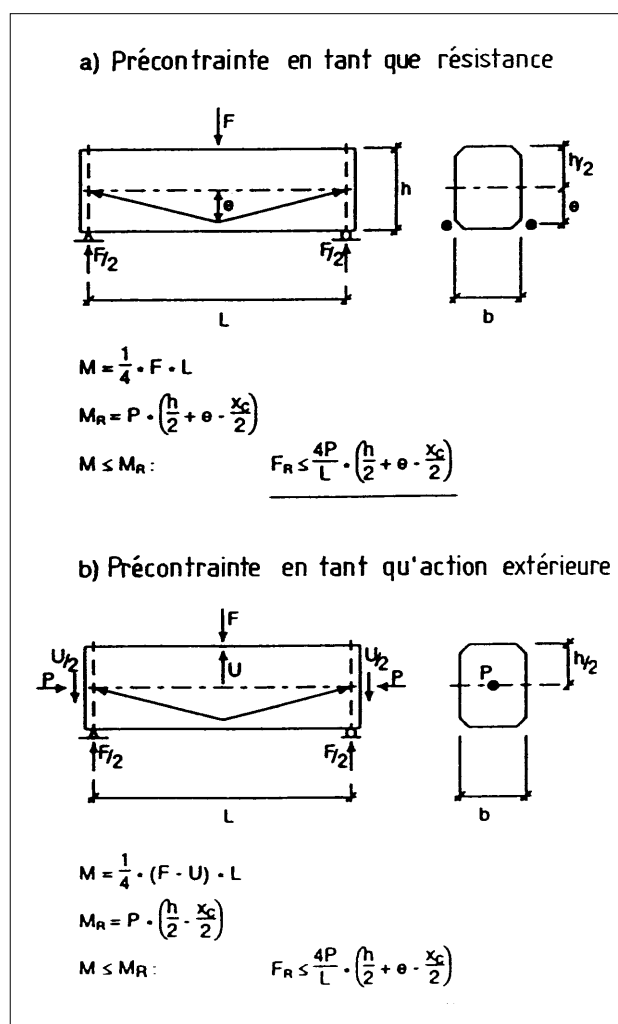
Effet d'une précontrainte extérieure sur une poutre:
